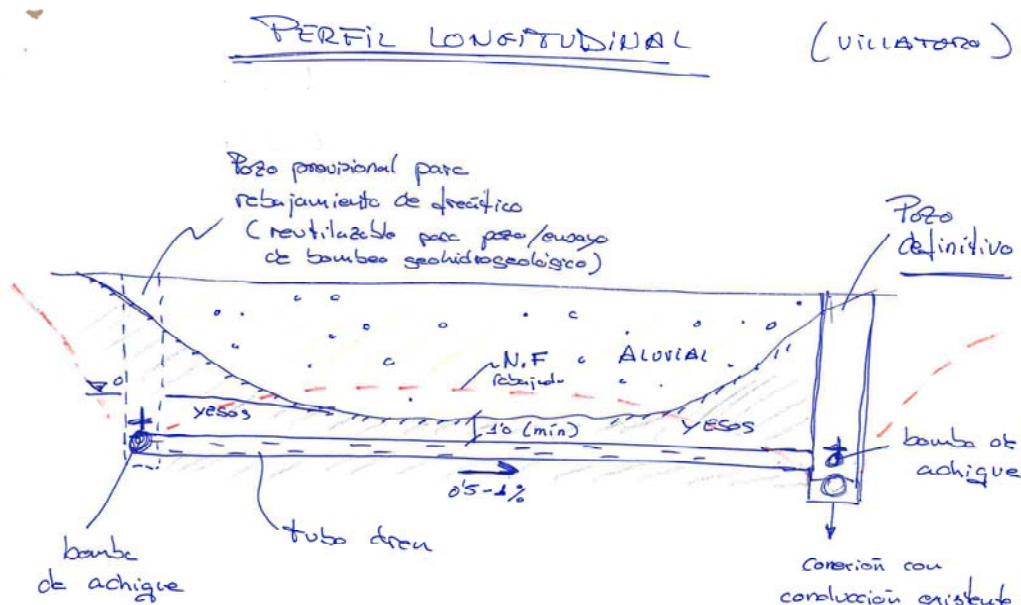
Perfil tipo longitudinal de la zanja y pozo/-os propuesta.
